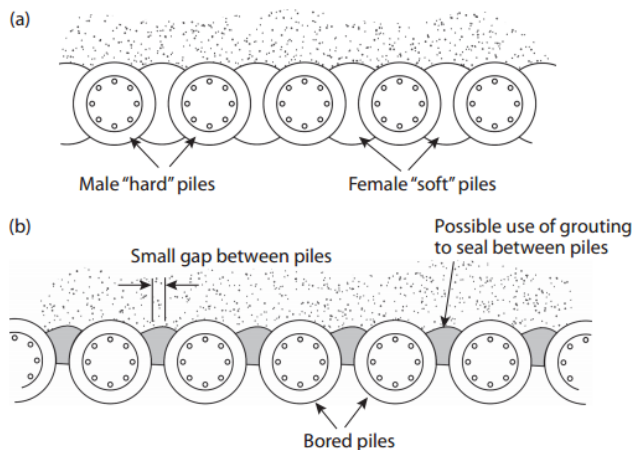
Vista em planta da instalação de cortinas de estacas: a)secantes e b)contíguas. (fonte: Groundwater Lowering in Construction [4])
